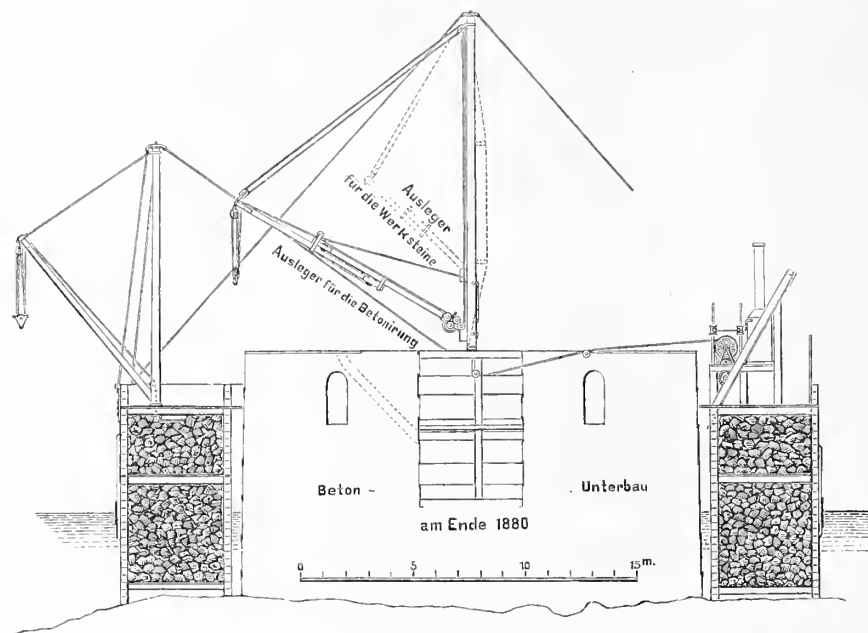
und 2. Durchschnitt und Grundriss vom Unterbau mit den Baumaschinen.
